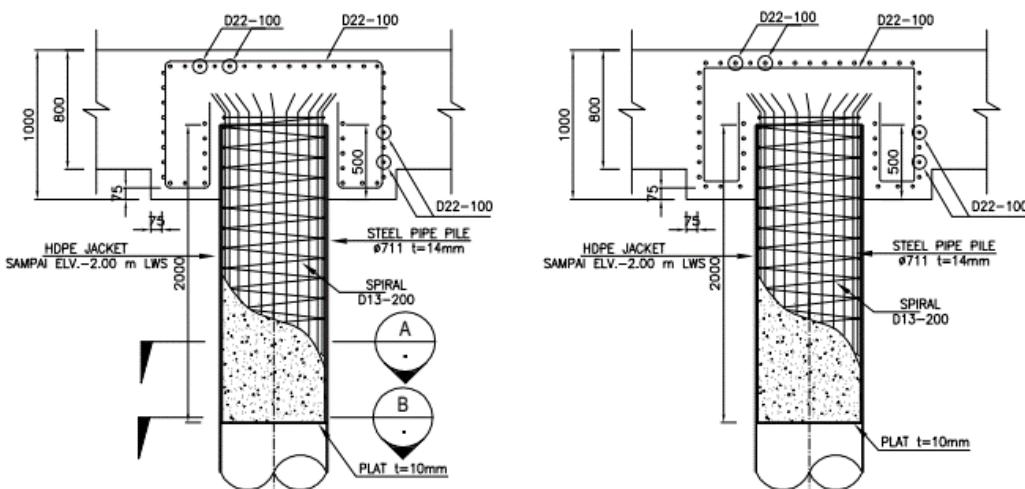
Detail penulangan kepala tiang 812 dan pilecap jetty
